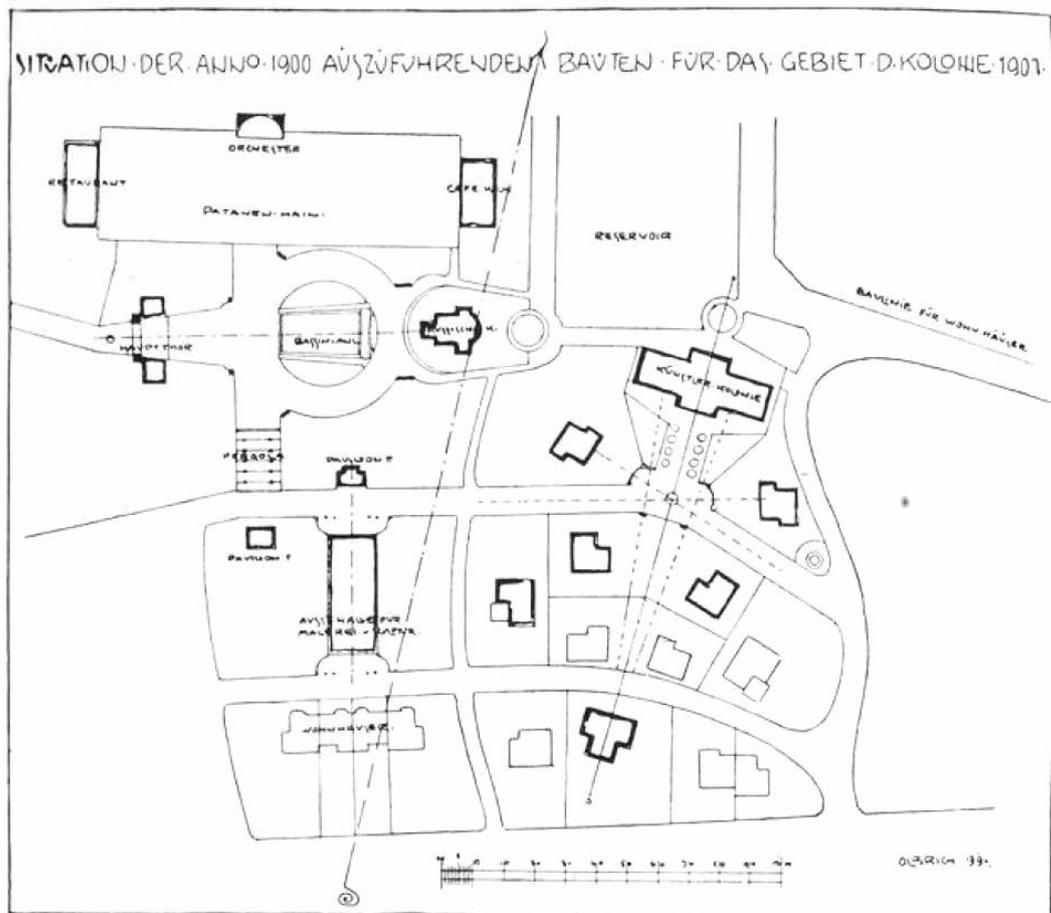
Planta de implantação desenhada por Olbrich, Darmstadt, 1901
